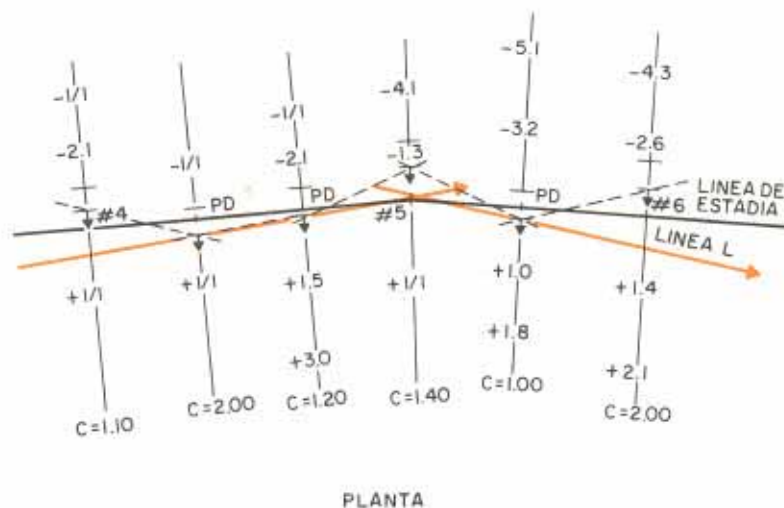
Plano de planta con indicación de los C y R iniciales, los ceros y el eje corregido.
